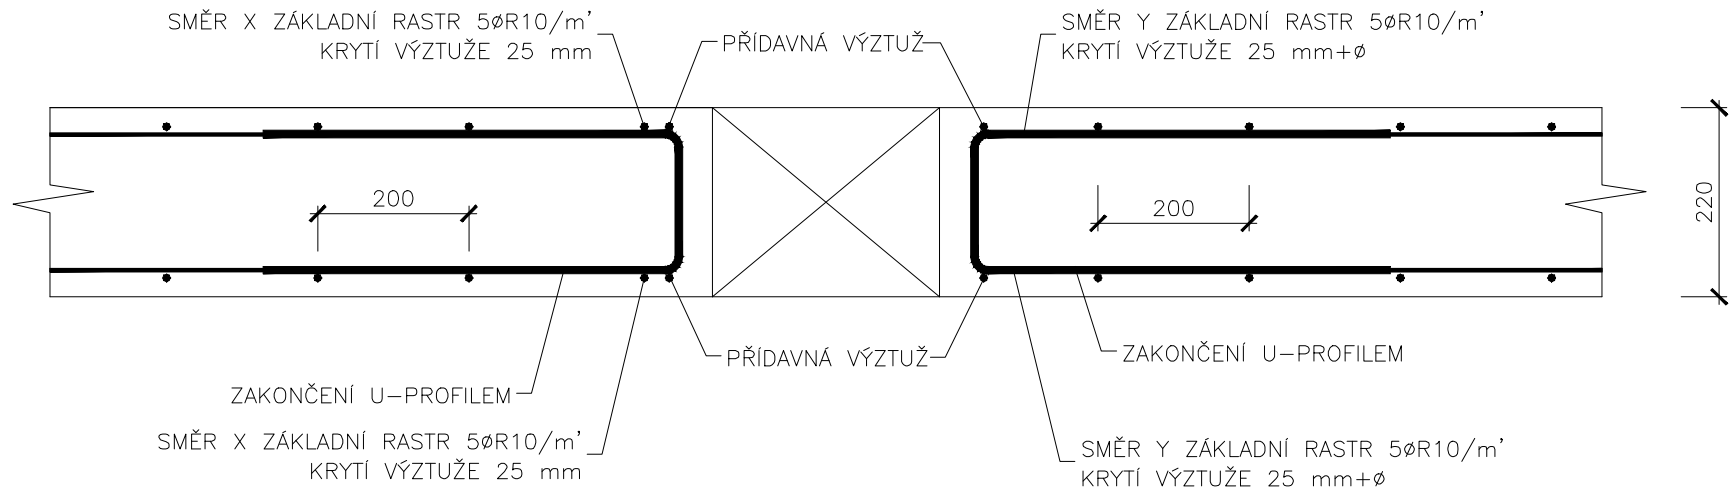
DETAIL ZAKONČENÍ VÝZTUŽE, M 1:10
